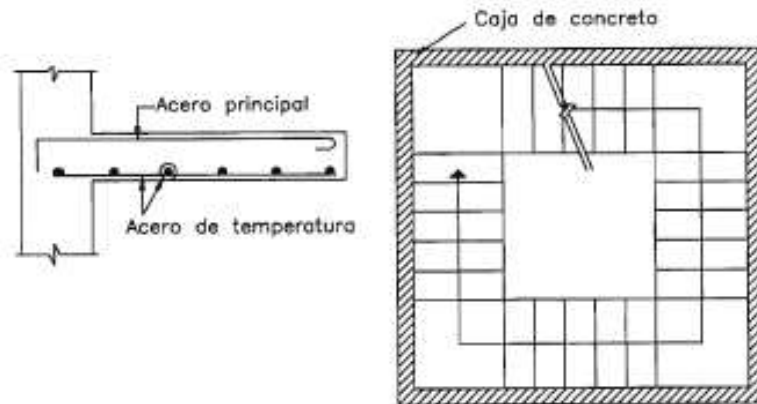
Escalera desarrollada dentro de caja de concreto
